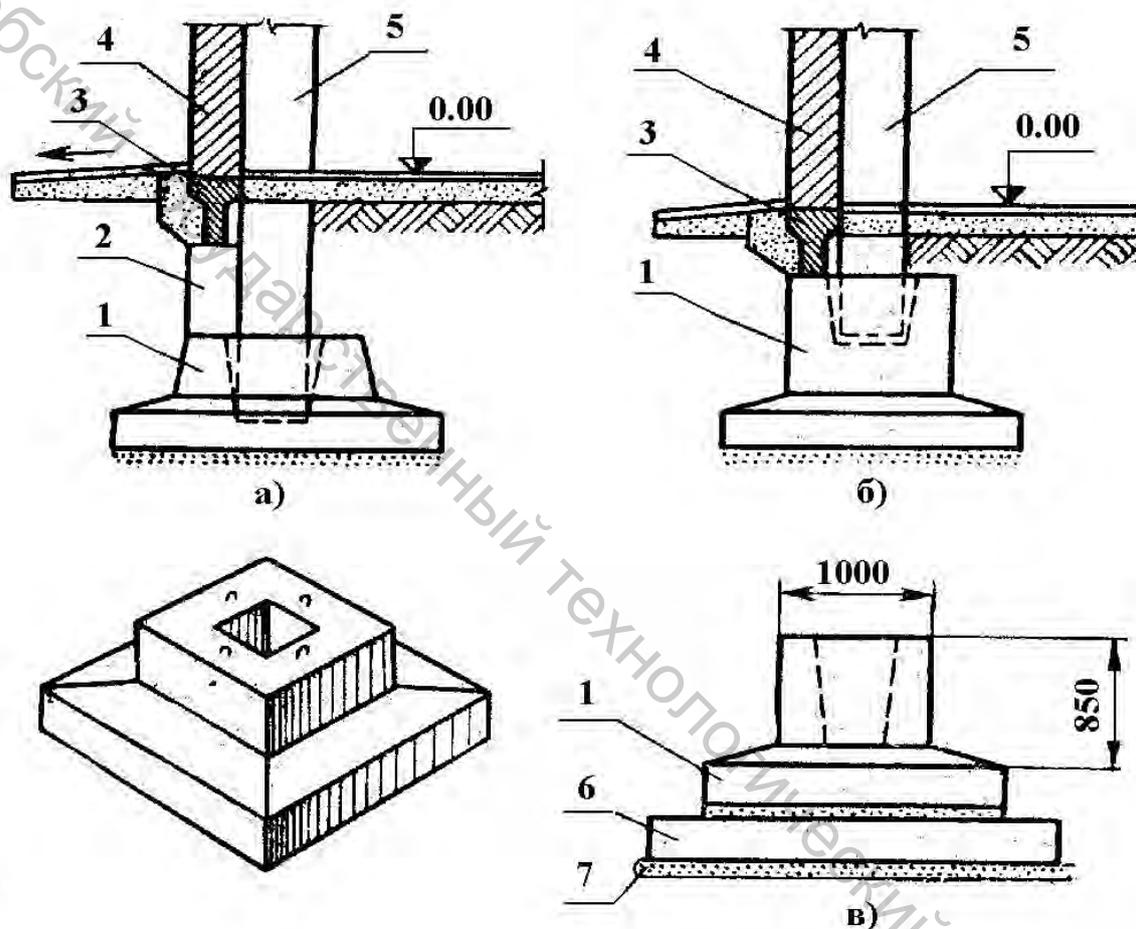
Сборные железобетонные фундаменты стаканного типа под колонны (а – стаканного типа; б – с повышенным стаканом; в – составной фундамент): 1 – фундамент (башмак); 2 – бетонный столбик; 3 – фундаментная балка; 4 – самонесущая стена; 5 – колонна; 6 – плита; 7 – бетонная подготовка
